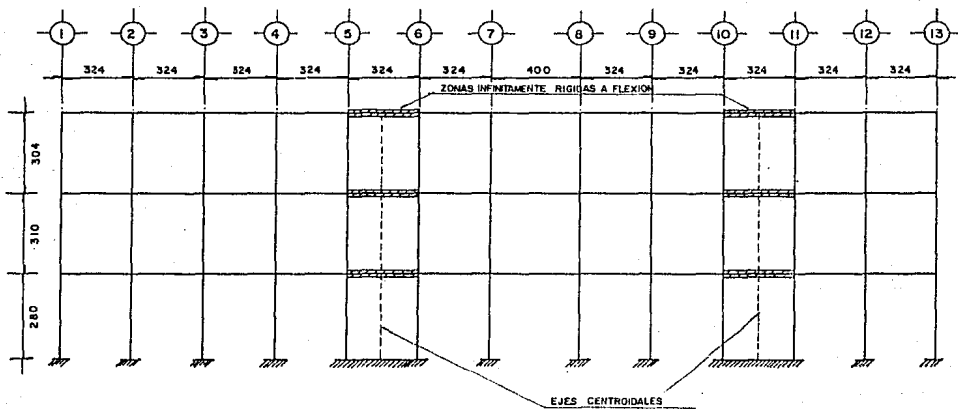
MARCO LONGITUDINAL CON MURO DE CONCRETO,
